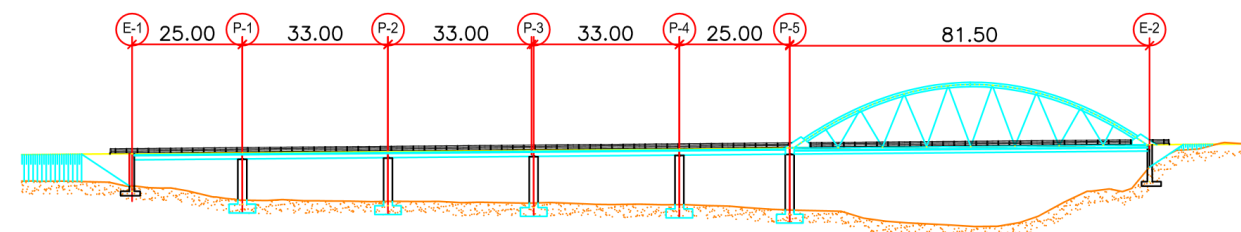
Sección del puente de la alternativa 1 (Fuente: AutoCAD)
